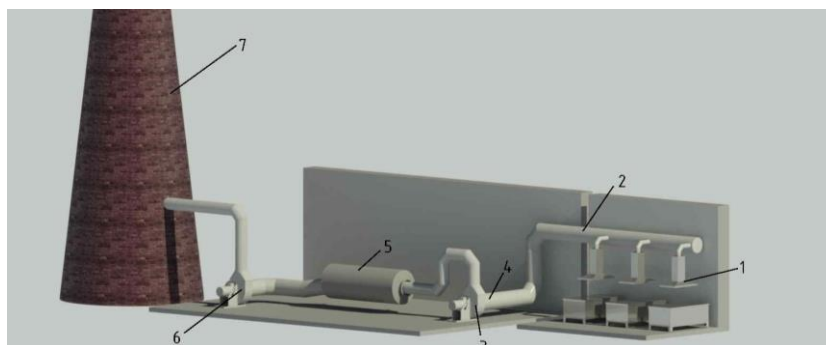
Схема транспорта промышленных вентиляционных выбросов, содержащих летучих органических соединений, в топку котлоагрегатов через вытяжной воздуховод системы производственной вентиляции: 1 – вытяжные зонты; 2 – сборный воздуховод вытяжной вентиляции; 3 – дутьевой вентилятор; 4 – всасывающий воздуховод вентилятора; 5 – котлоагрегат; 6 – дымосос; 7 – дымовая труба
